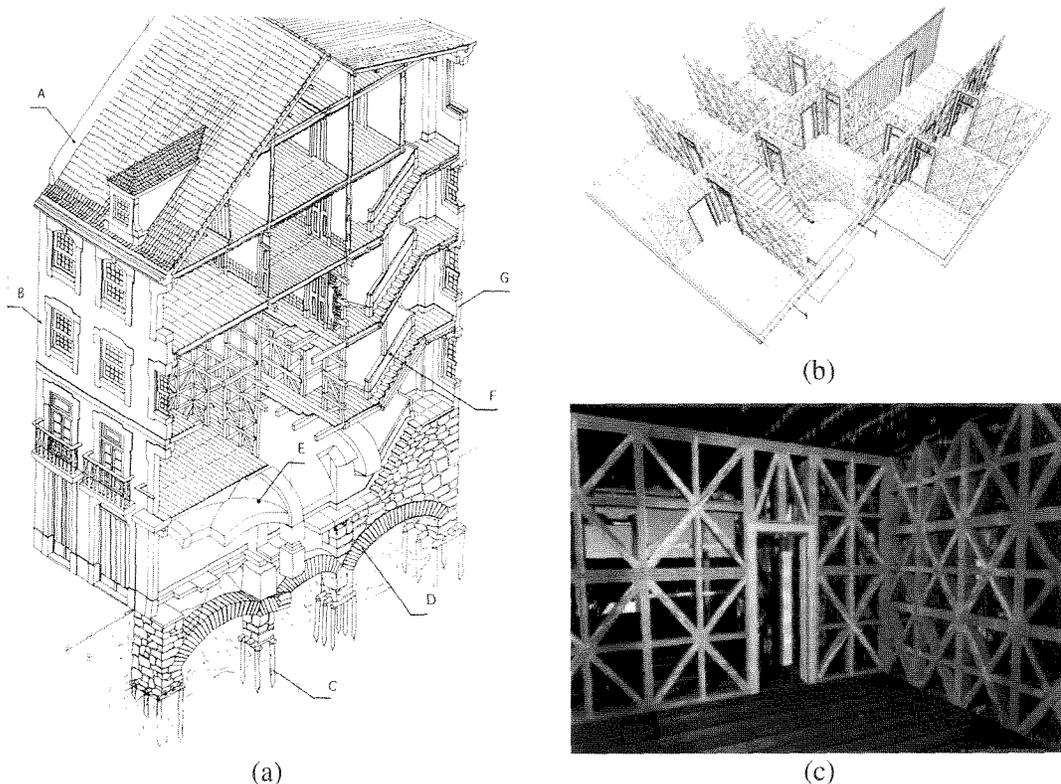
Pormenores construtivos: (a) perspectiva em corte das construções pombalinas: A – paredes corta fogo; B – fachadas em paredes de alvenaria de pedra grossas; C – sistema de estacas; D – arcos em pedra; E – abóbadas em pedra no primeiro piso; F – parede que dificultava a ascensão rápida dos fumos pelas escadas; G – as escadas eram sempre colocadas junto dos logradouros para facilitar a sua iluminação; (b) perspectiva de um piso formado por gaiolas pombalinas; e (c) imagem virtual do interior de um edifício
